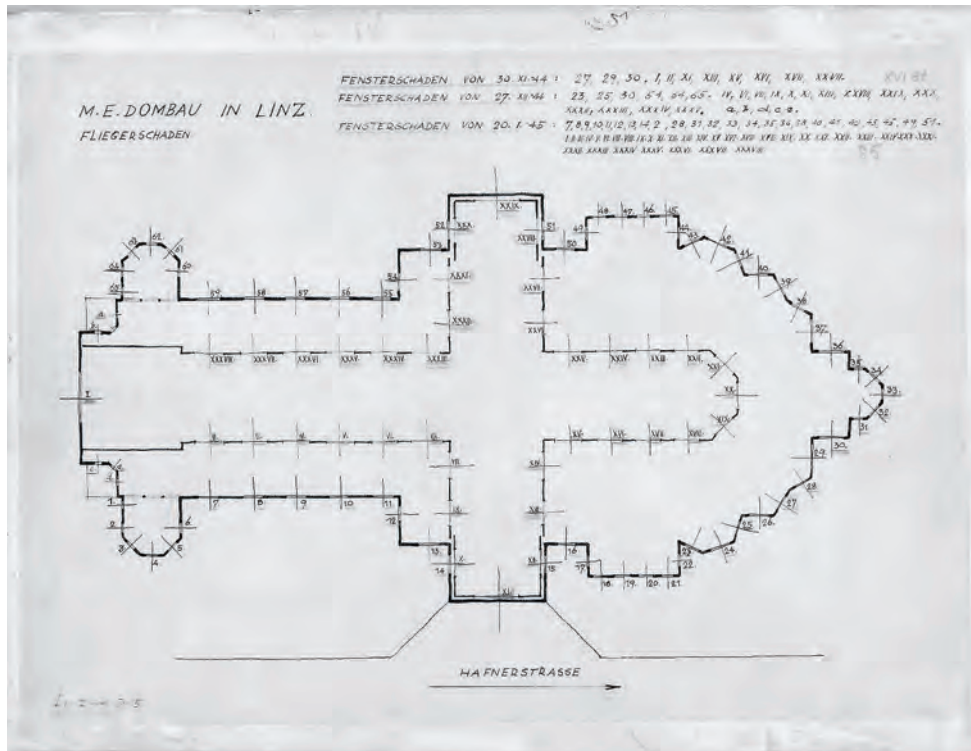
Grundrissplan des Doms mit Kennzeichnung der durch die drei Fliegerbomben am 30.11.1944, 27.12.1944 und 20.1.1945 jeweils am stärksten betroffenen Fenster
